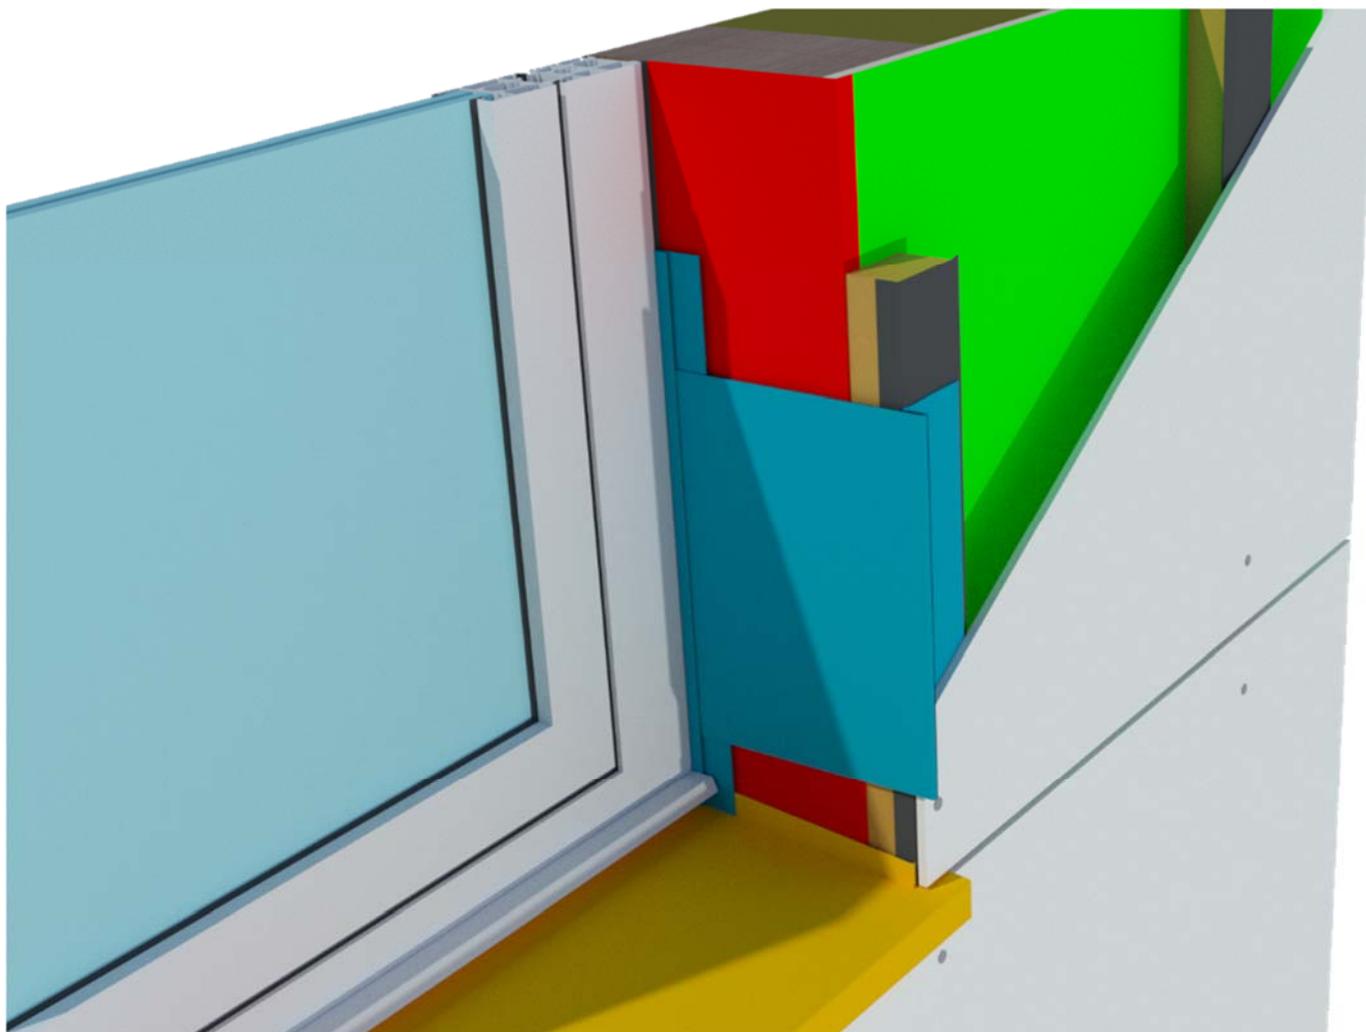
Pose sur COB – Coupe sur appui de baie
